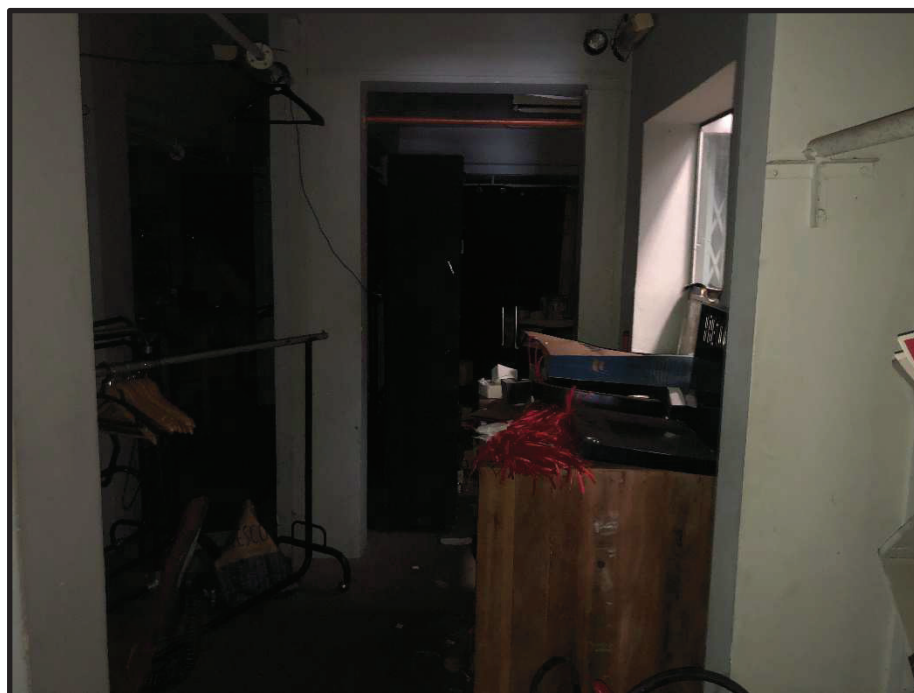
Pavimento Térreo – Hall de acesso as salas
